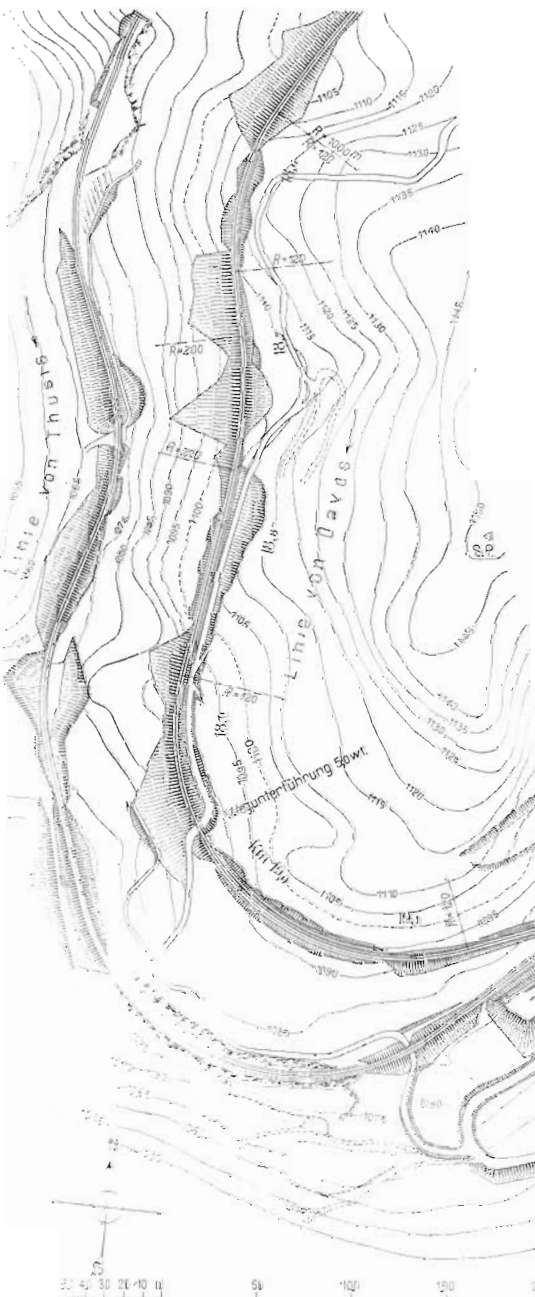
Lageplan der Einmündung der Linie von Davos in die Albualinie auf der Station Filisur.
